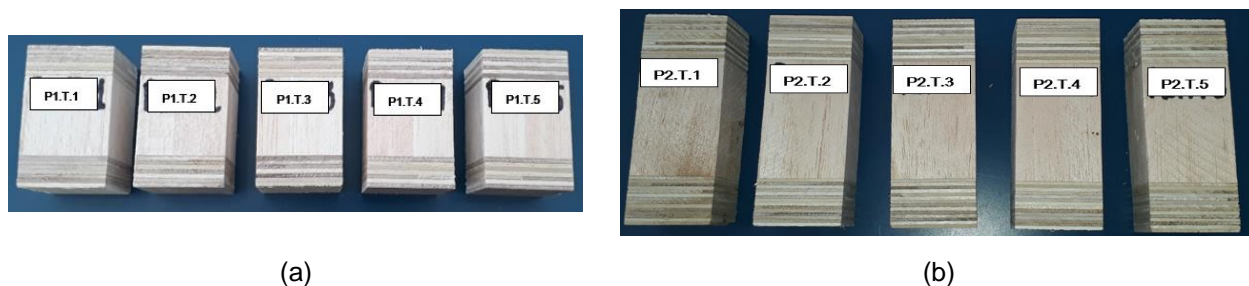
Muestras para ensayo de tracción (a) prototipo de tablero estructural 1 y (b) prototipo de tablero estructural 2
